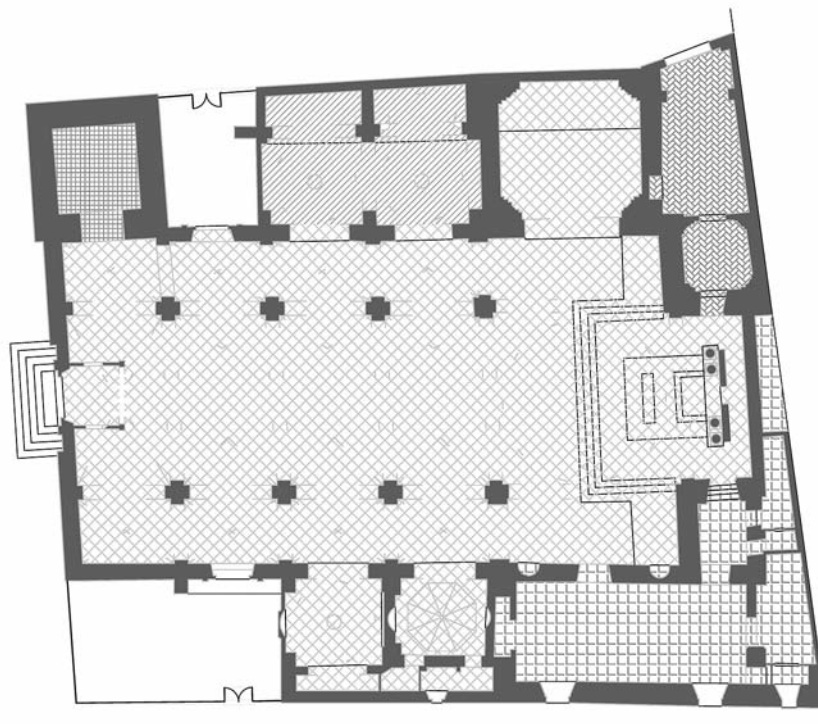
Plano de planta general de la iglesia incluido en el PFC, con distinción de los pavimentos.
